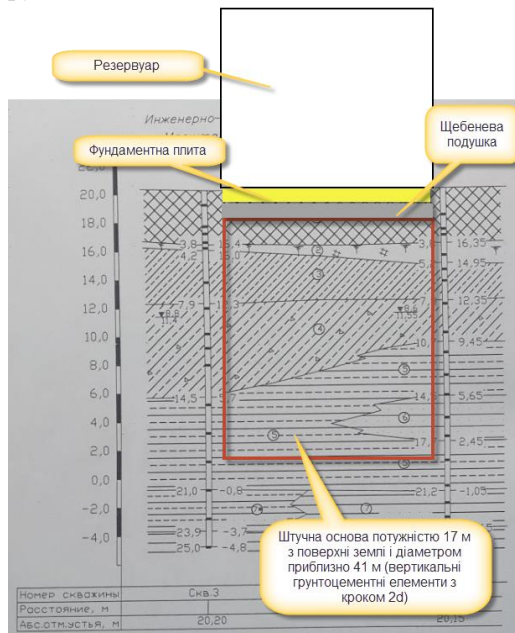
Розрахункова схема системи «ґрунтовий масив – підсилена основа – щебенева демпферна подушка – фундаментна плита – резервуар»
